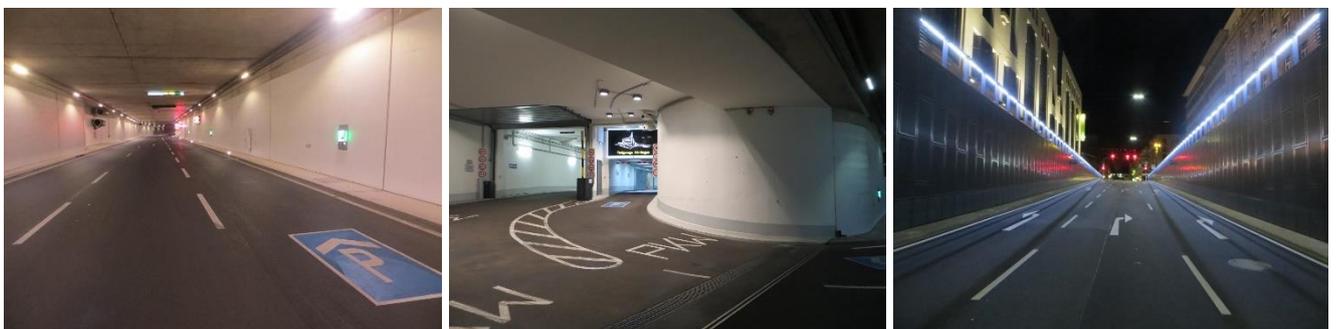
Tunnel, accès aux parkings souterrains et rampes d'accès
